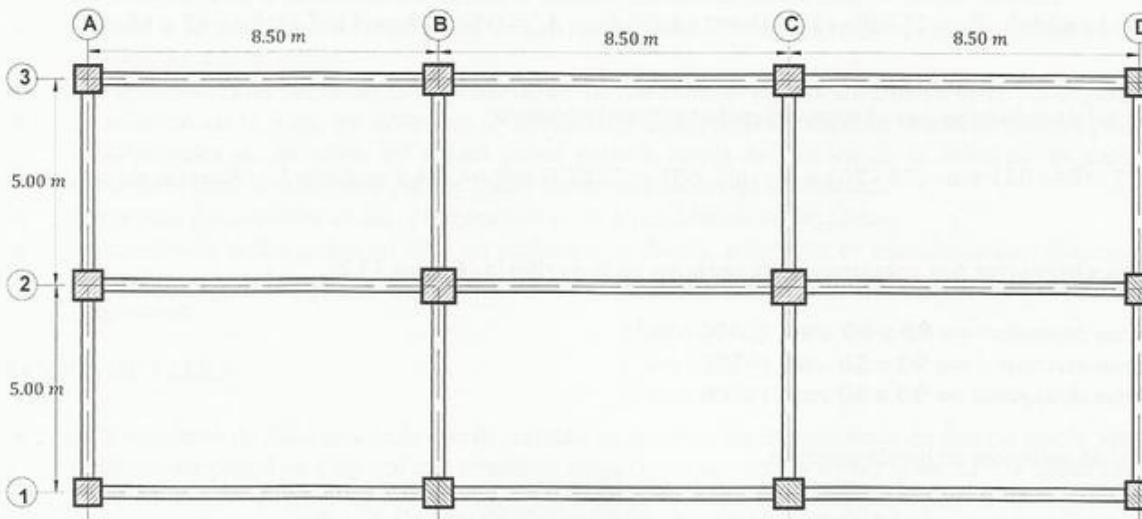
Planta del edificio del Ejemplo 13.1
